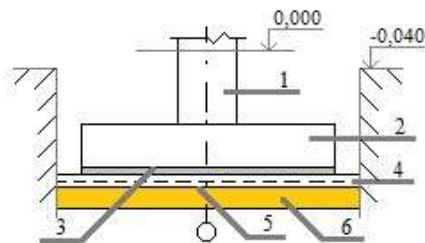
Сборный элемент колонна-фундамент, установленный в среднем ряду : 1 – колонна, 2 – фундаментная плита В45 (500 мм), 3 – выравнивающая подливка из бетона В20 (70 мм), 4 – подготовка из бетона В20, армированная сеткой из стержней 6-Вр500С с ячейкой 150×150 мм (130 мм), 5 – пленка полиэтиленовая (1 слой), 6 – утрамбованный щебень (300 мм)
